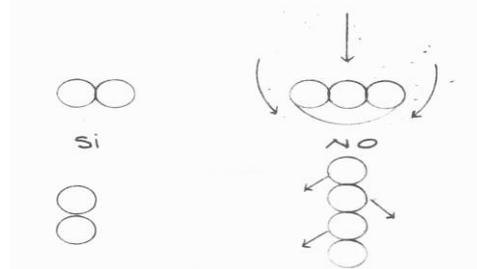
Forma correcta de agrupar cables de presfuerzo
